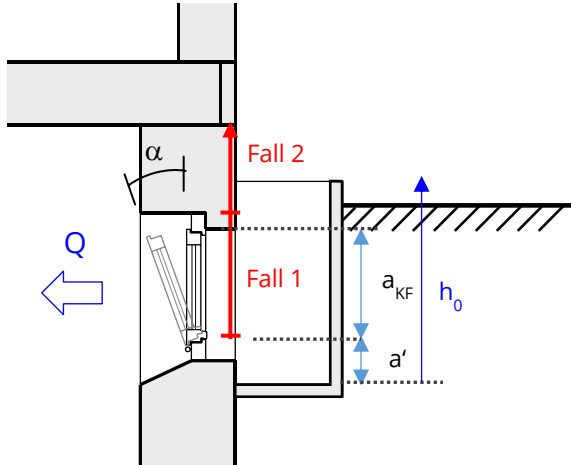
Hydraulisches System – Wassereintritt über Kellerfenster mit Lichtschacht (Zeichnung: IÖR, modifiziert)
